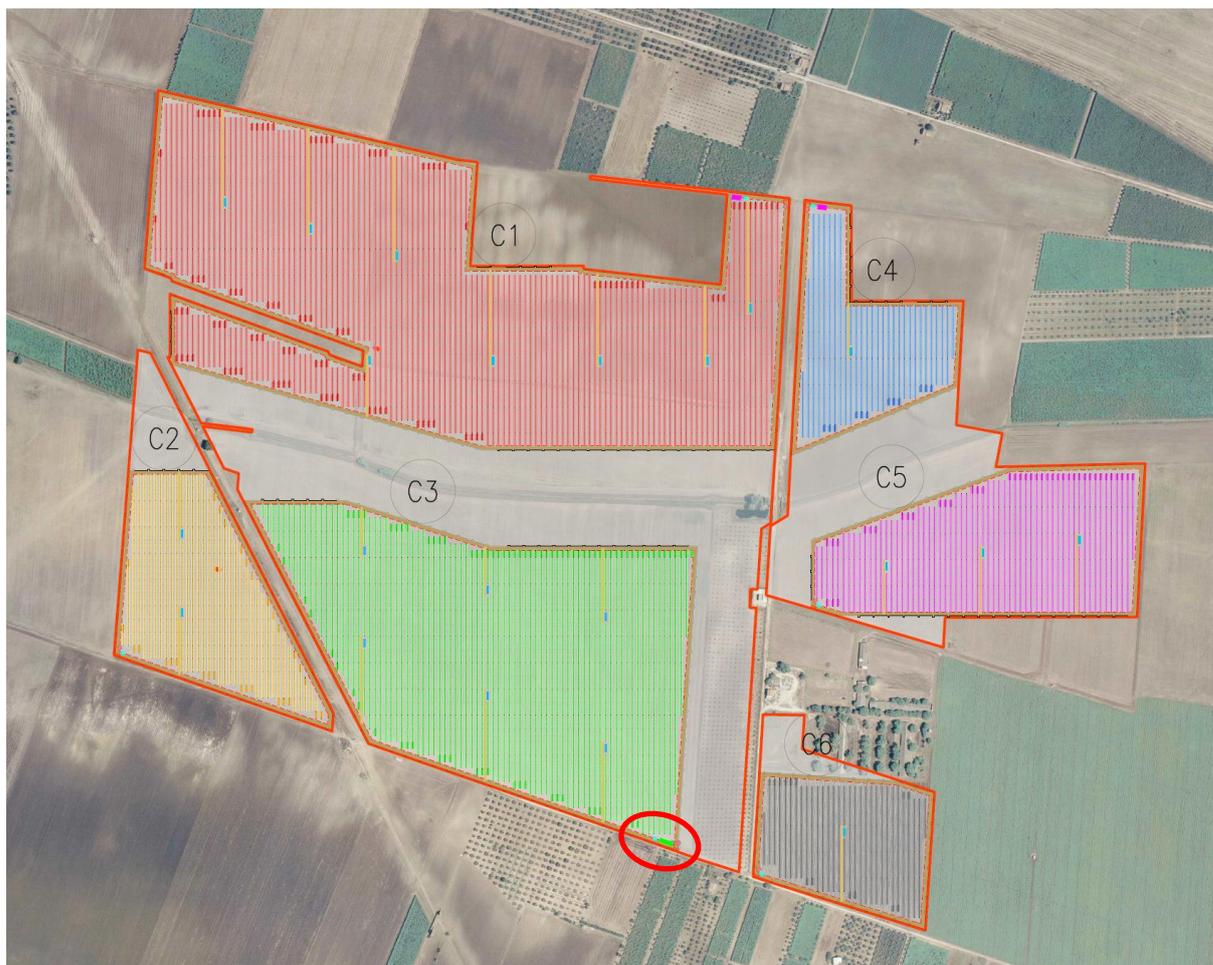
Spazi accessori dell'impianto (particolare delle tavole progettuali), in rosso
